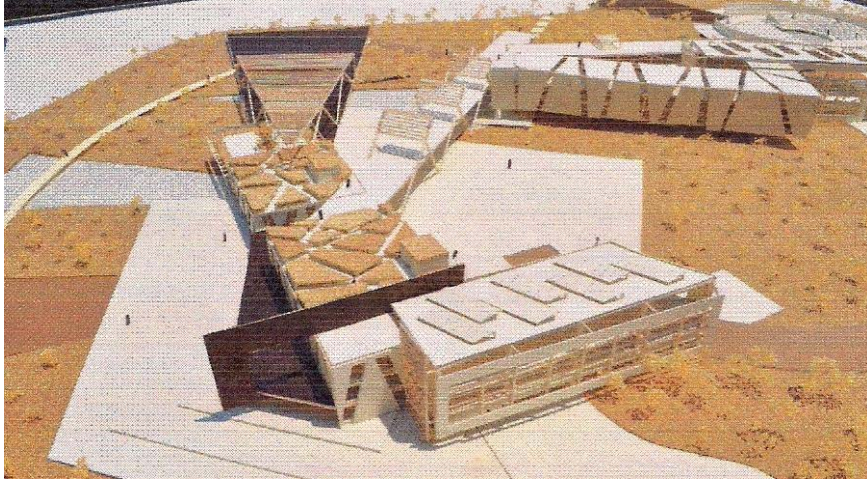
Techos verdes en la cubierta del edificio A y B
